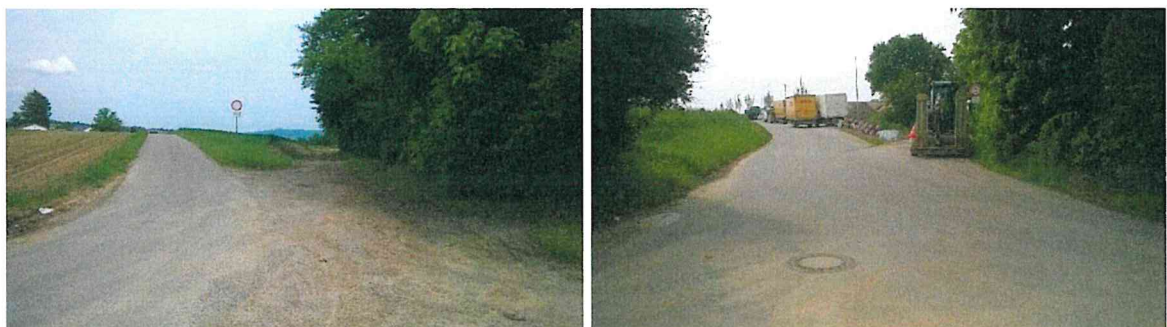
und 6: Anschluss an bestehende Liebigstraße, Blickrichtung nach Osten und Westen
